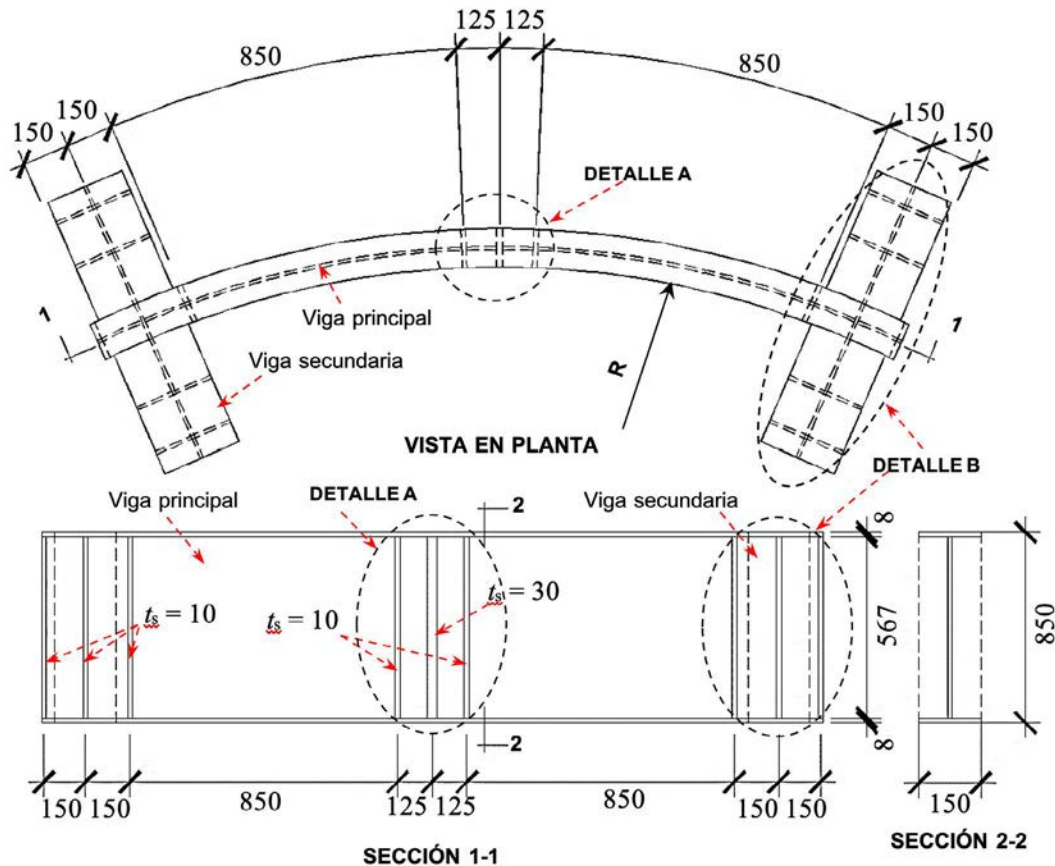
Vista en planta y detalles de la sección transversal de las vigas ensayadas por Shanmugam et al. [2].
